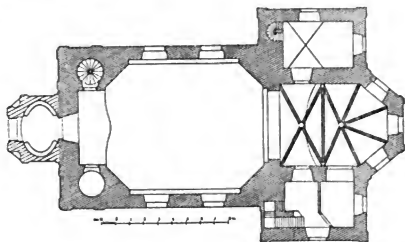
Wosek. Grundriss der Kirche.
